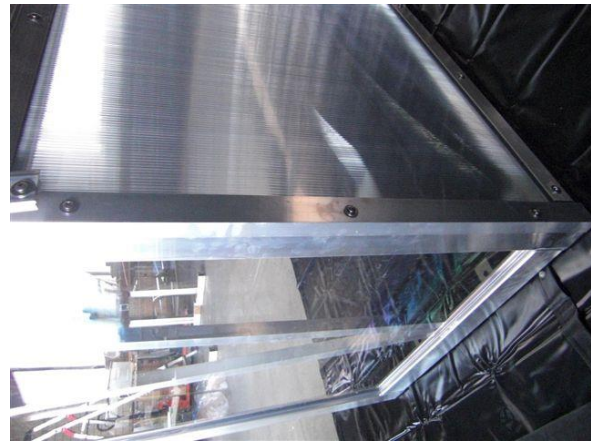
Winkel 50x30x2mm wieder mit den vorher herausgedrehten Schrauben befestigen. Alle Schrauben anziehen. Jetzt auch die in Bild 6 nur locker eingedrehten Schrauben festziehen.
